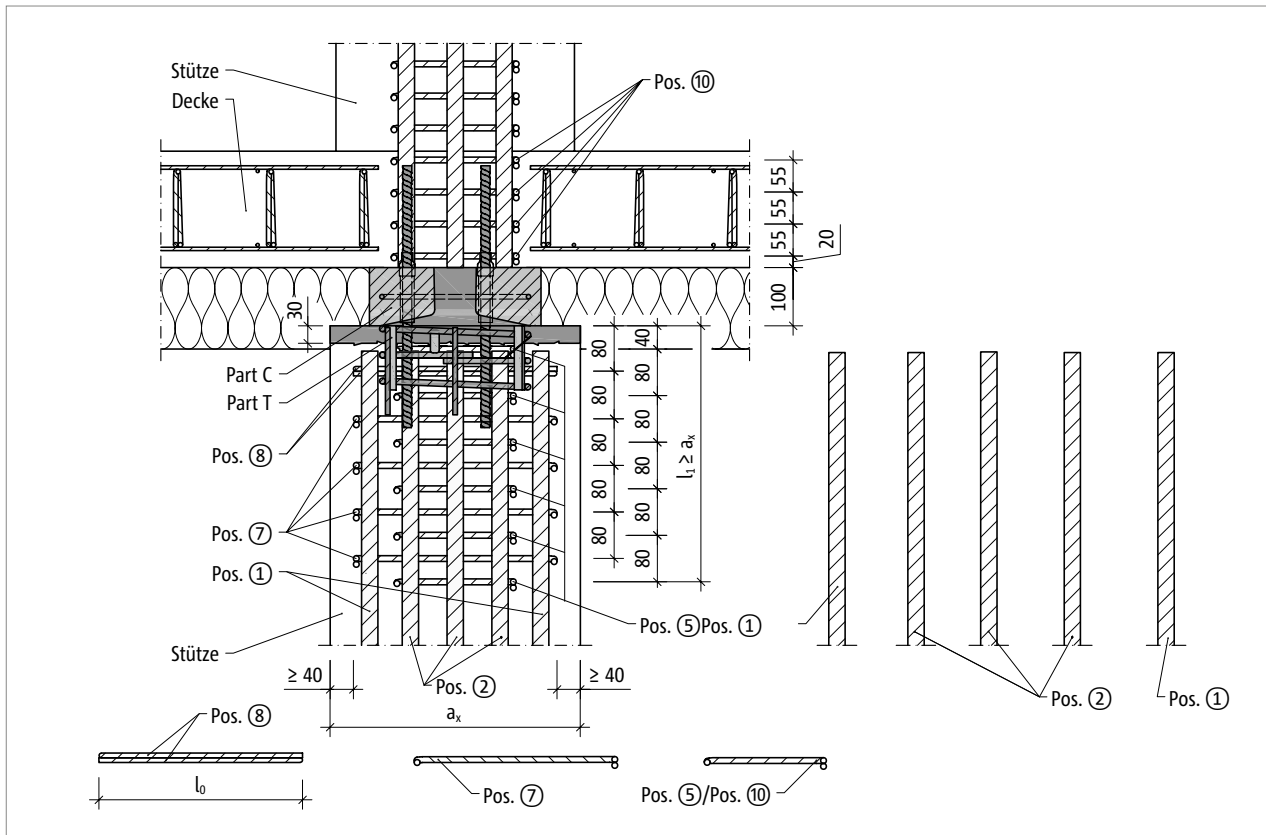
Schöck Scconnex® Typ P: Bauseitige Bewehrung im Stützenlängsschnitt A-A
